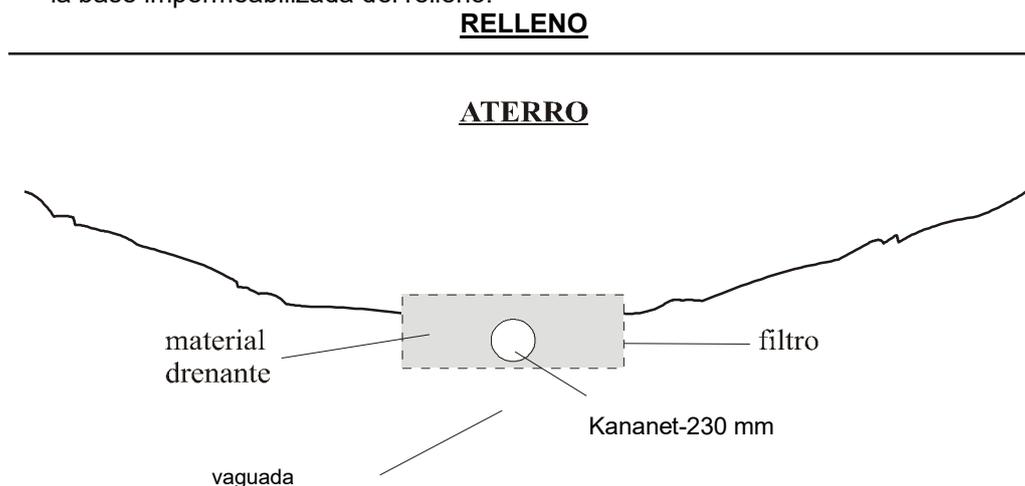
Corte longitudinal de un relleno dotado de drenaje de vaguada, transversal a su eje.
